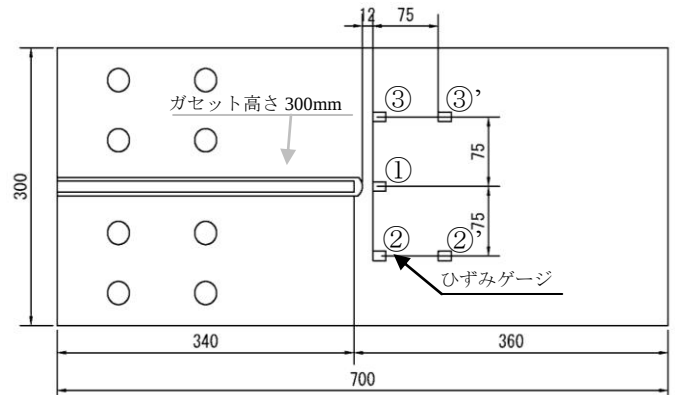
試験体寸法とひずみゲージ貼付位置 (mm)
